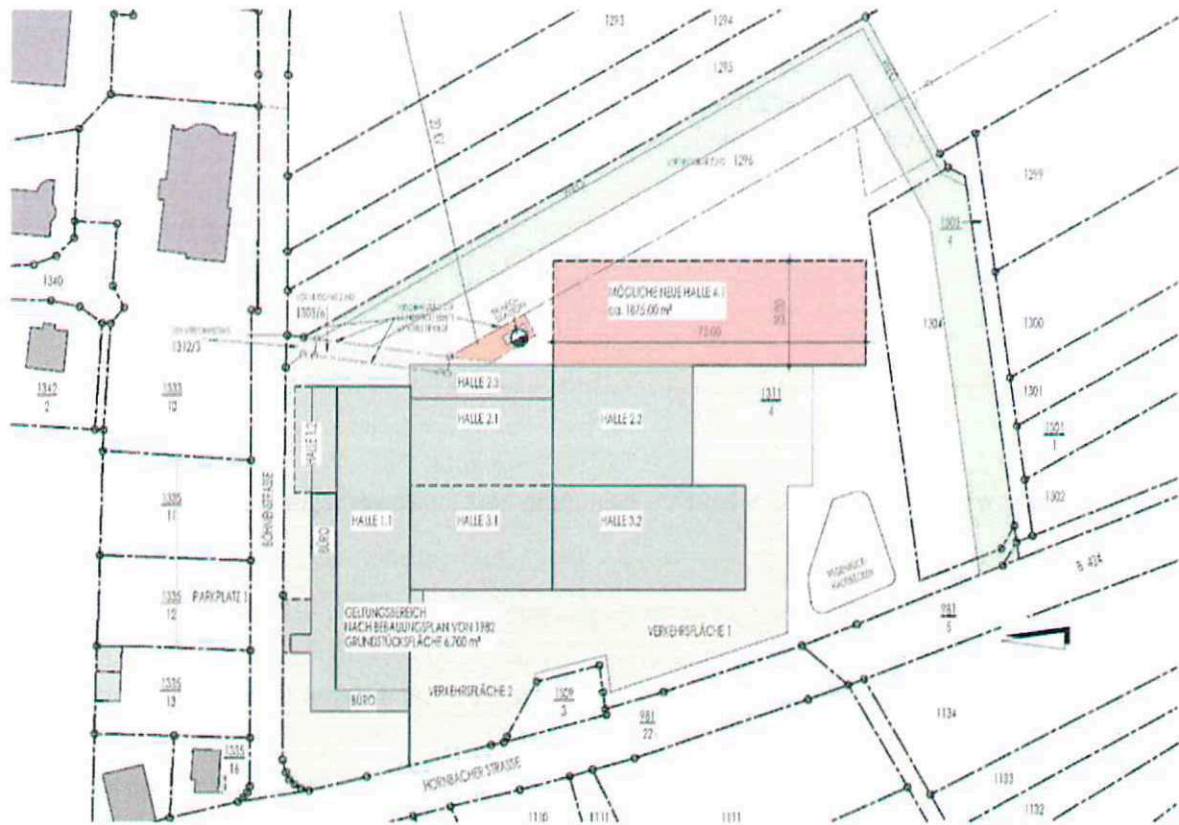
Lageplan – Mögliche Erweiterung Halle 4.1 (Wilhelm Architekten 02/2023)
